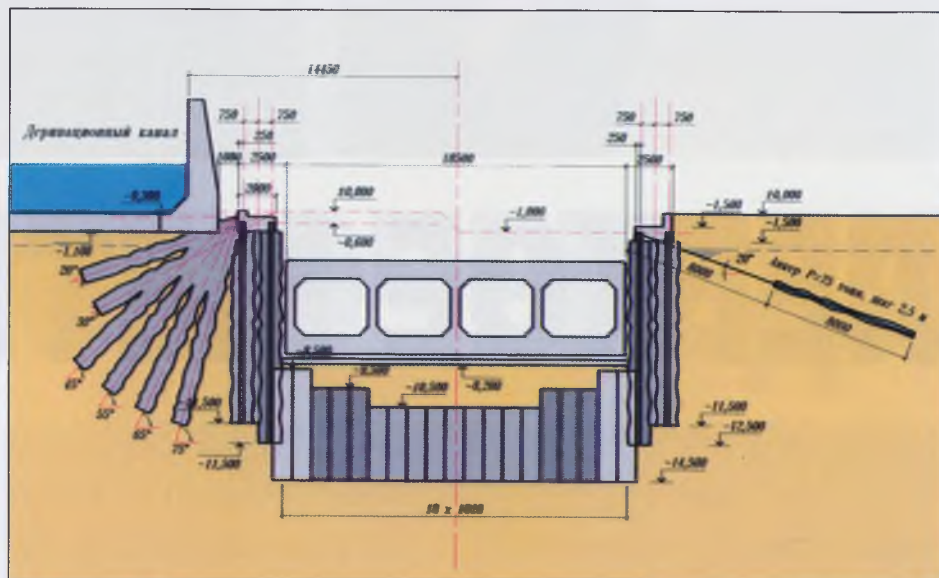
Строительство четырехочкового гидротехнического тоннеля-сифона. Выполнение грунтоцементных свай-колонн ограждения и веерных анкерных свай крепления котлована вблизи отведенного канала
